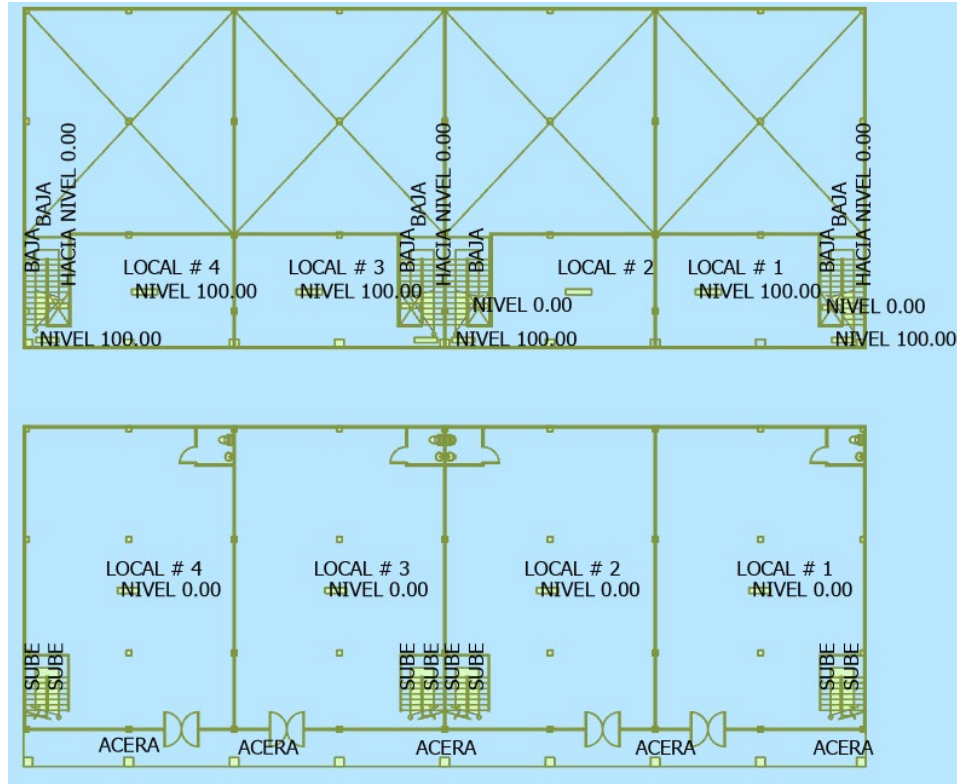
Vista general de los locales comerciales con la plata alta (nivel 100). Fuente: Planos del proyecto, 2024.
